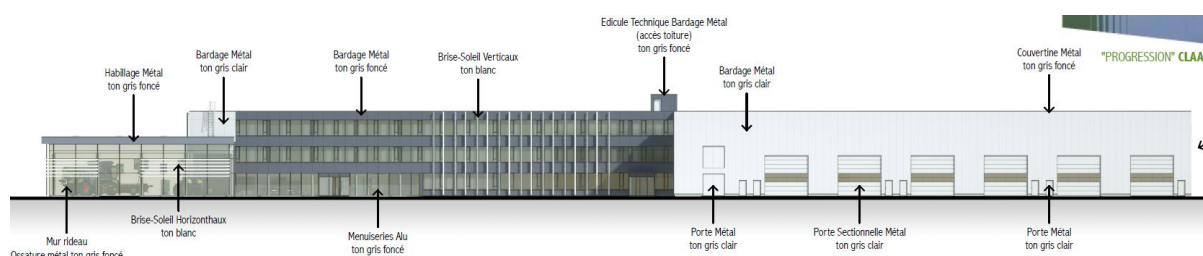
Façade du siège social (Extrait de la Notice du Permis de construire)
